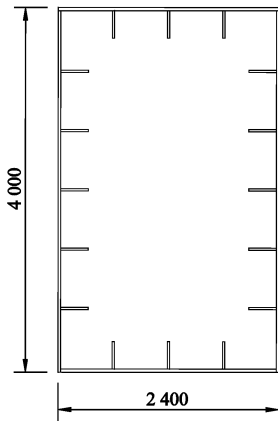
菜园坝大桥拱肋断面图 (单位: mm)
